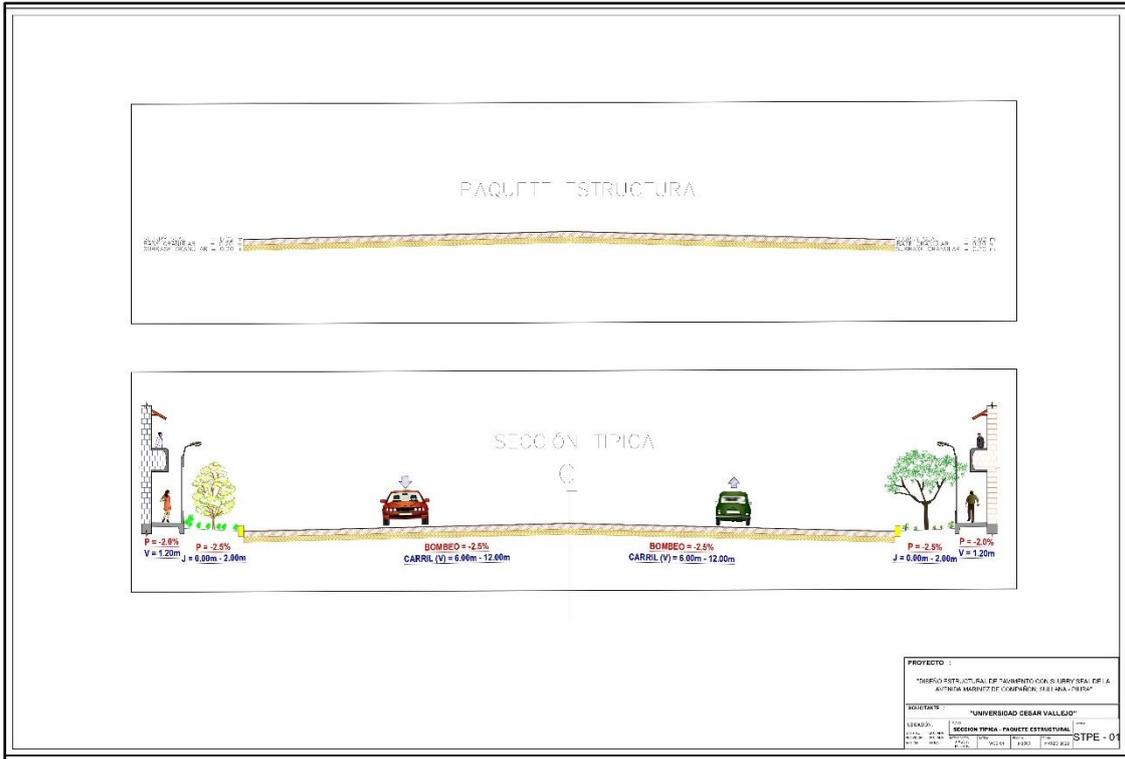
Lámina con detalle del paquete estructural y sección típica
